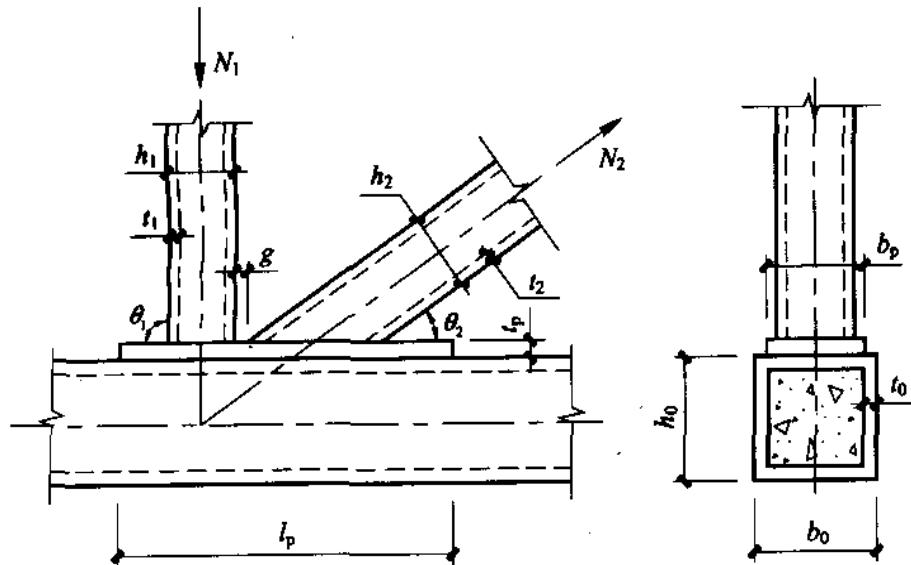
翼缘焊接钢板的节点加强措施
